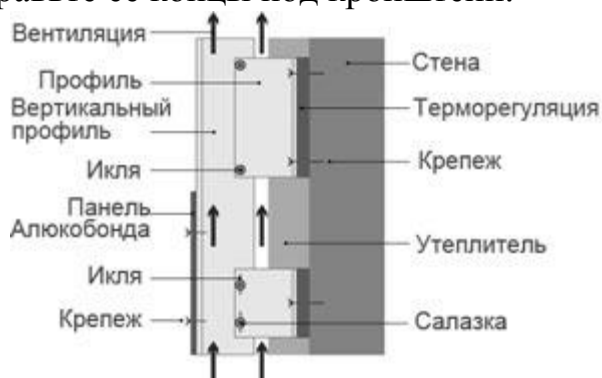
Схема вентилируемого фасада из панелей Алюкобонда
